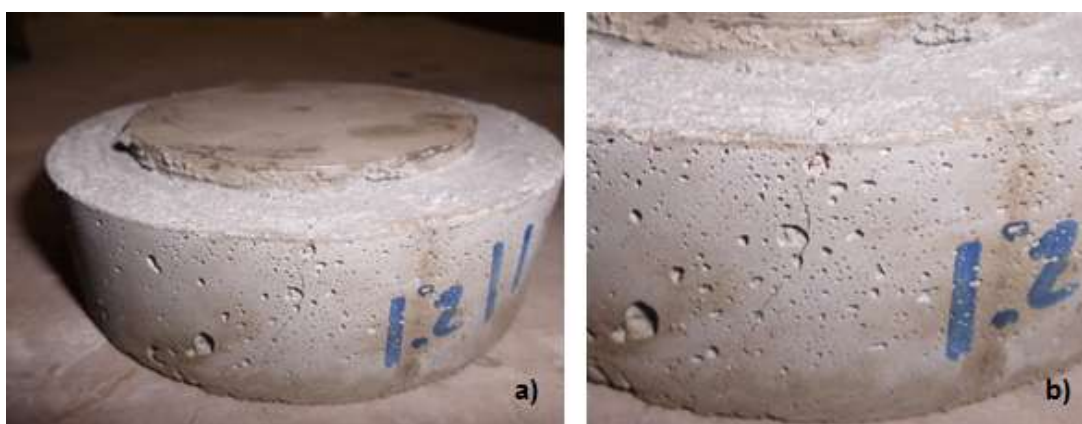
Fissuração do provete da argamassa PCM-SB-1 no ensaio do Anel (a) e pormenor (b).
